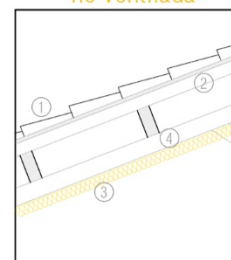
Cubierta de la casa de Aguilar tras restauración.
